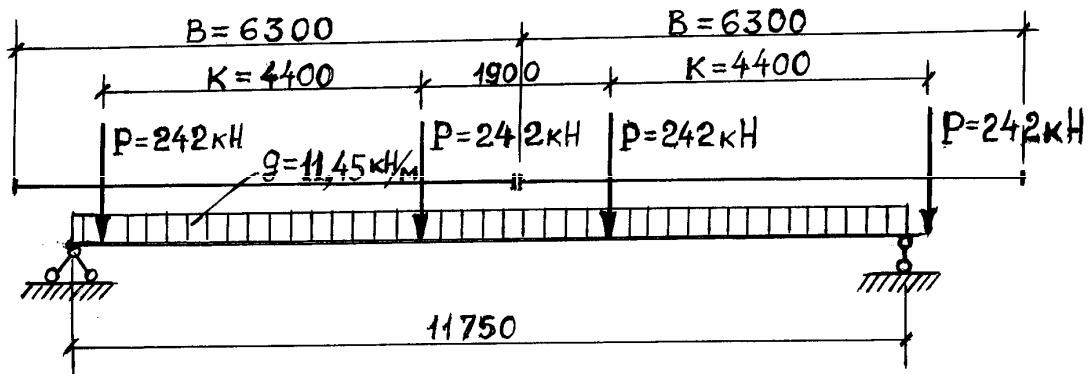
Розрахункова схема підкранової балки $L=12$ м
